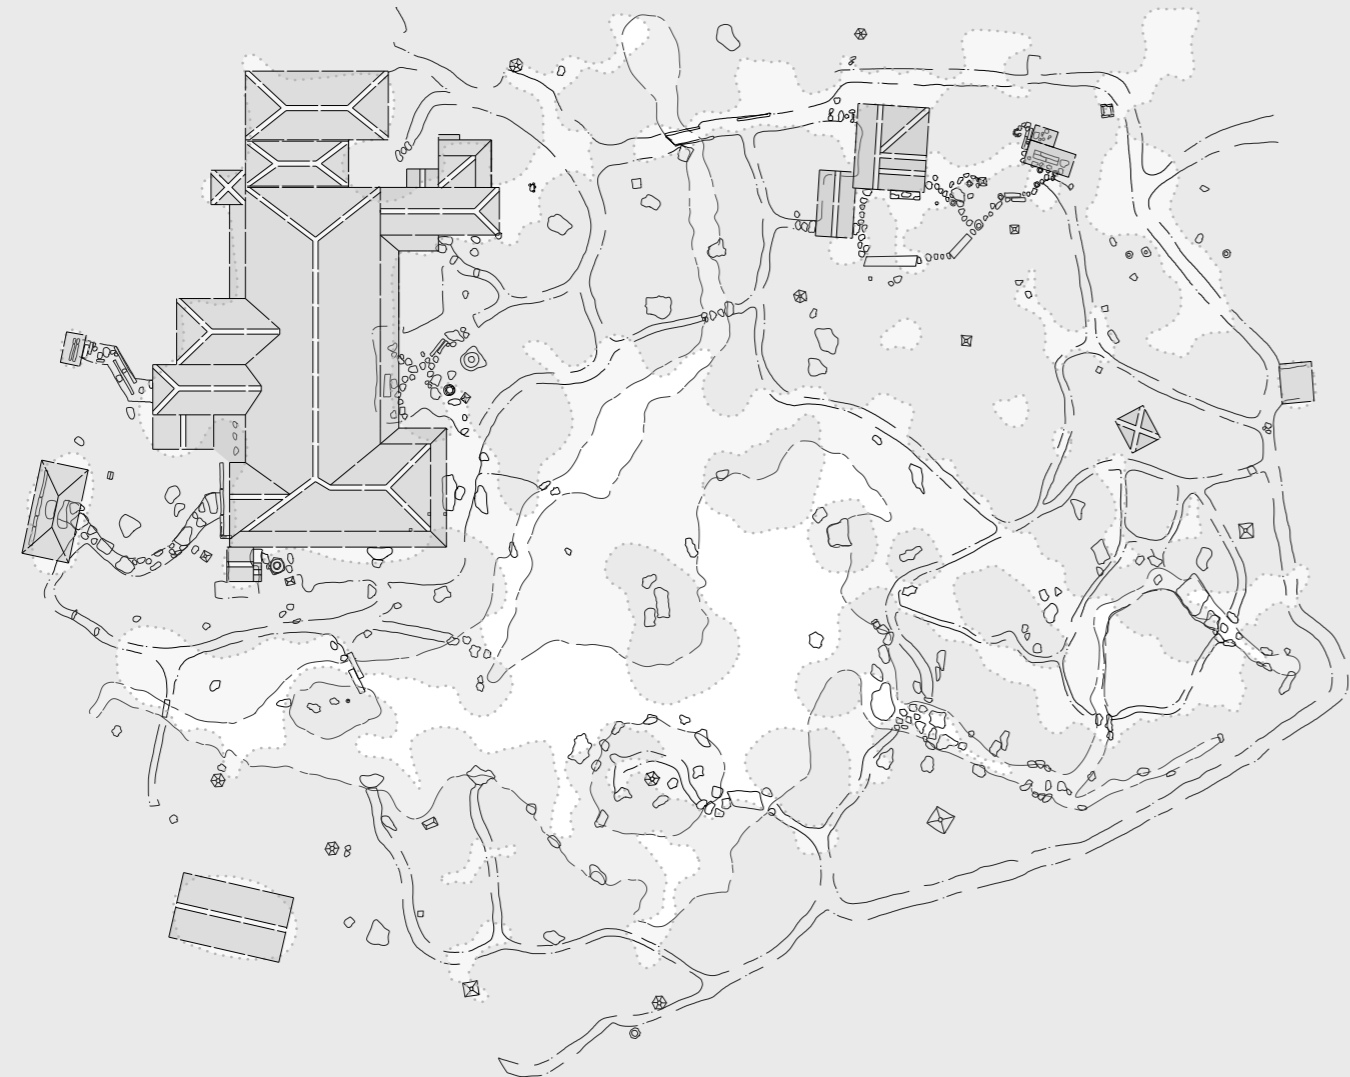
Planta del jardín de Kaiu-so. Escala 1/500
